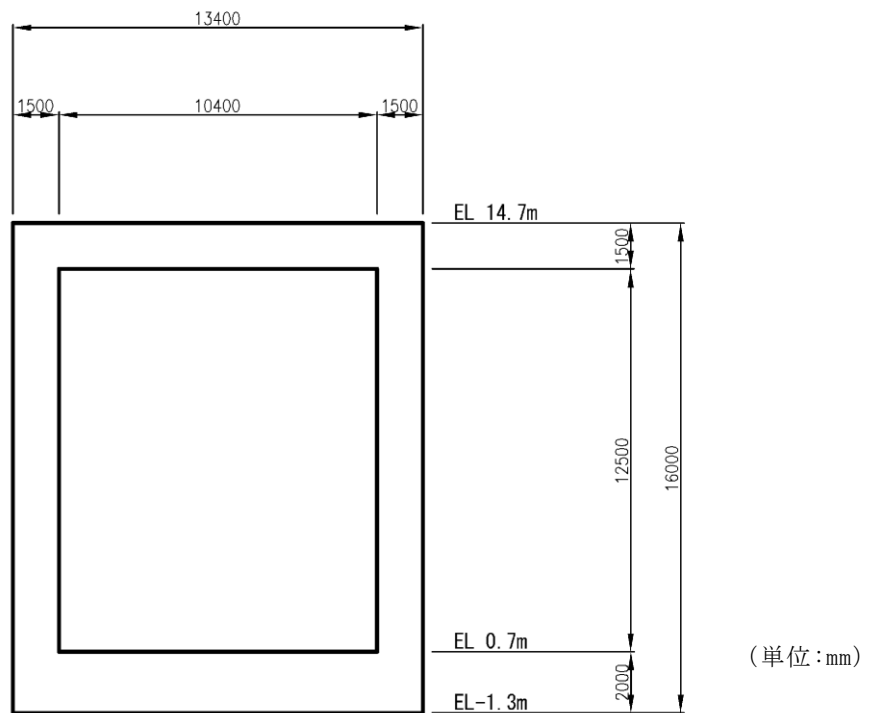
低圧原子炉代替注水ポンプ格納槽 断面図 (B-B断面)
